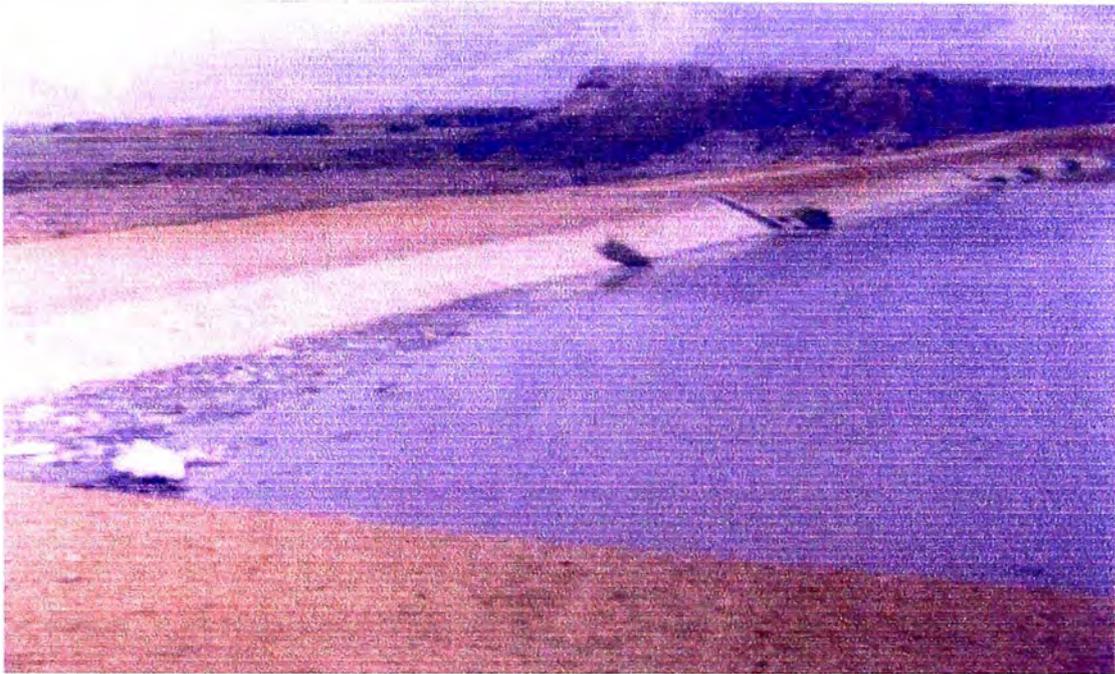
Nótese que el talud esta revestido con mamposterla de piedra, para protegerlo de la erosión. Foto Laguna de Moche. Trujillo.
